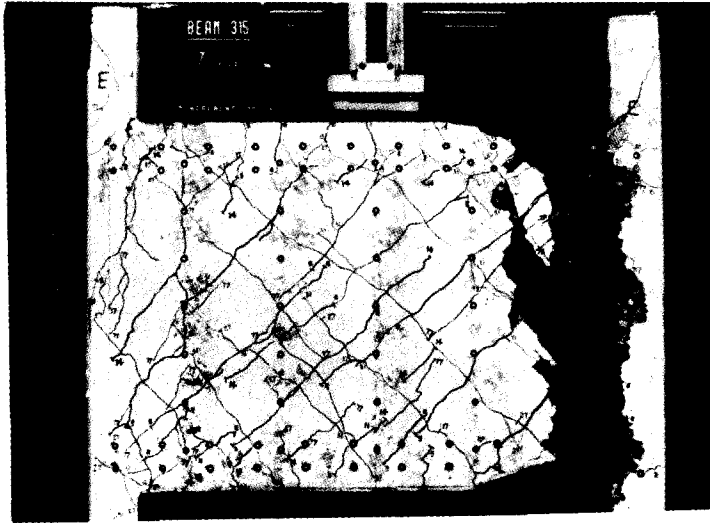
Grietas por tensión diagonal y falla de deslizamiento por cortante, en una viga de acoplamiento
